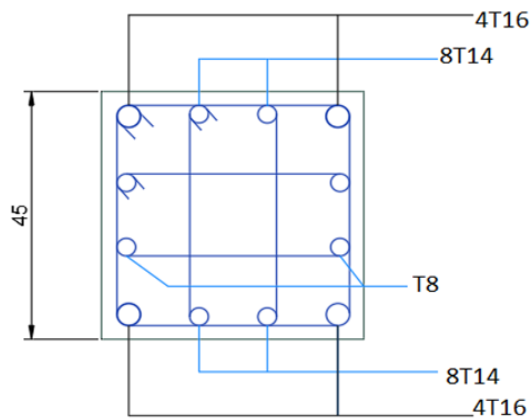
Schéma de ferrailage des poteaux(45;45)
